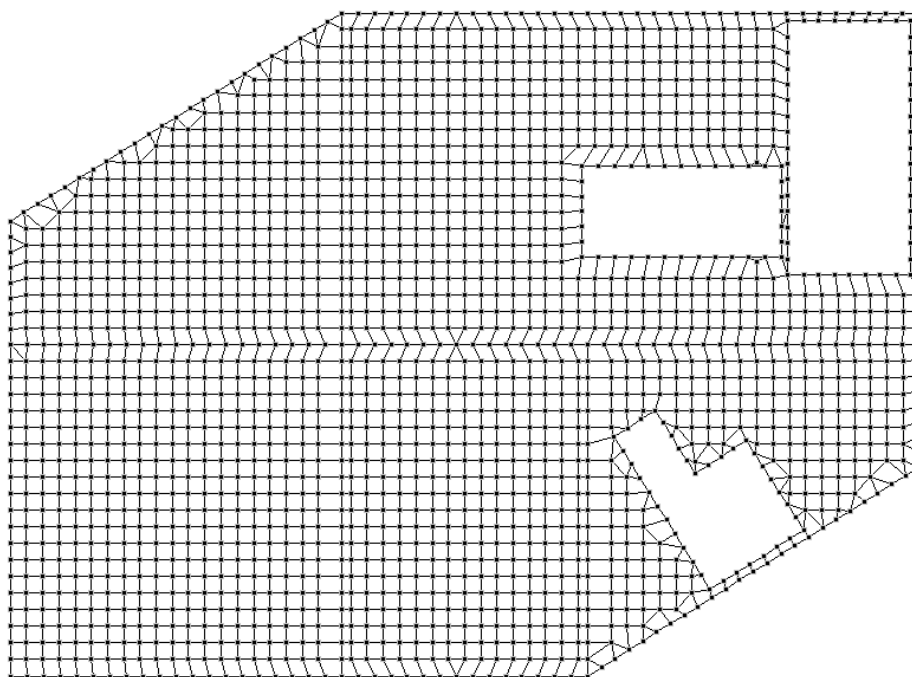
Расчетная схема монолитной плиты перекрытия на отм. 0,000.
